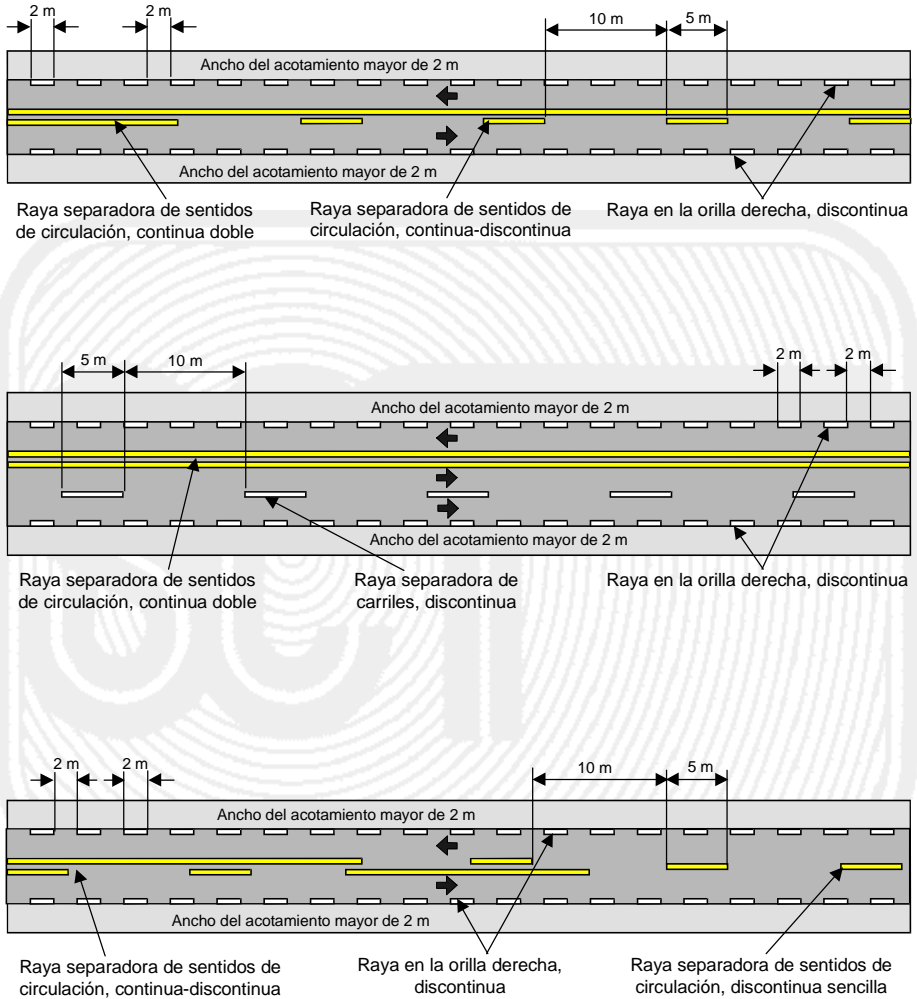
Marcas en el pavimento en carreteras con ancho de calzada mayor de 6,5 m
